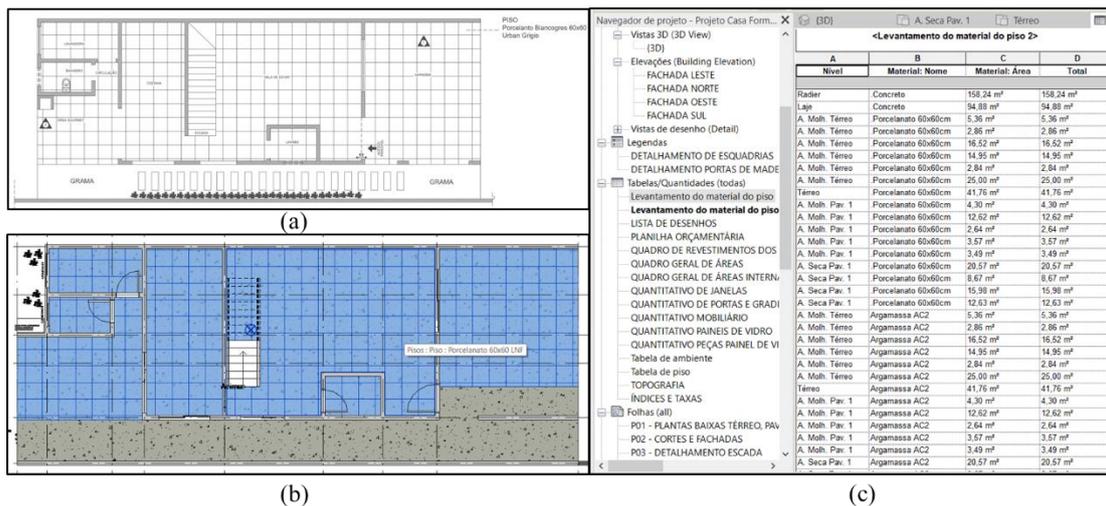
Planta de piso no AutoCAD (a), planta de piso no Revit (b) e levantamento de quantitativos no Revit (c). (FONTE: acervo da autora).
